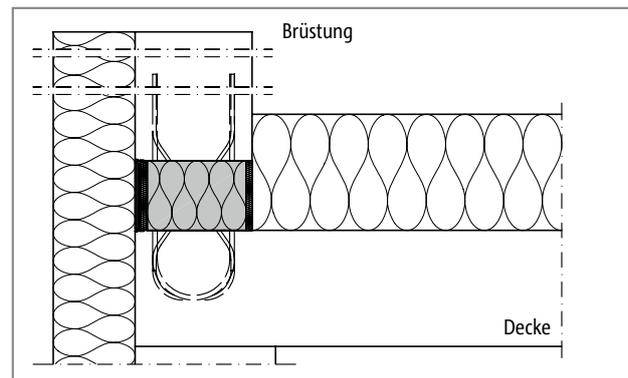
Schöck Isokorb® XT Typ ZL bei EI120 mit Schöck Isokorb® XT Typ AP: Brandschutzplatte oben und unten
